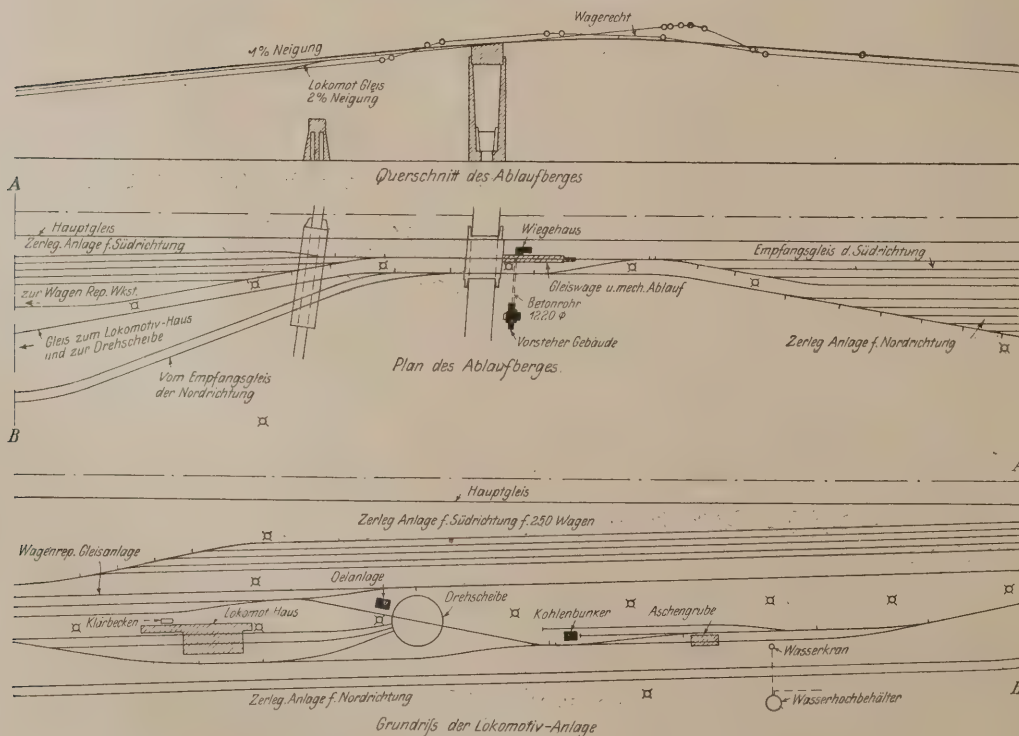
Verschiebebahnhof mit Nebenanlagen.
